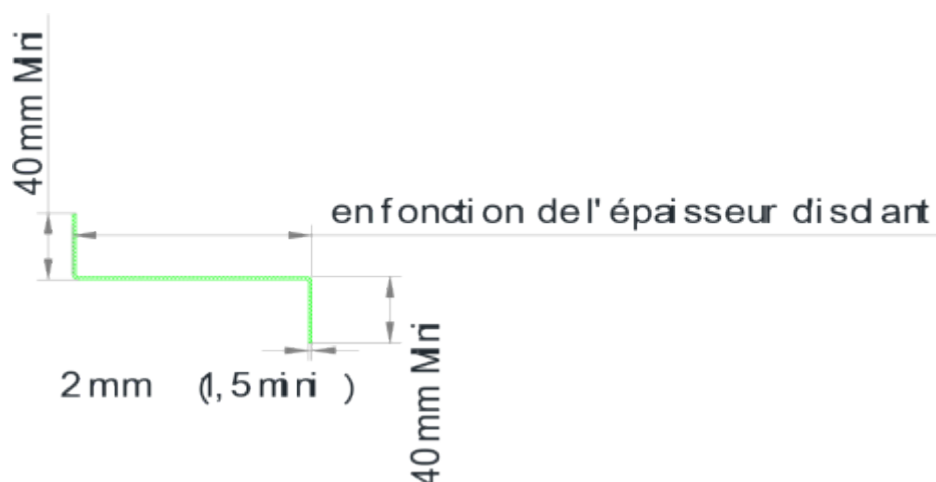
Profil de reprise de bavette et remplacement des lèvres de plateaux
